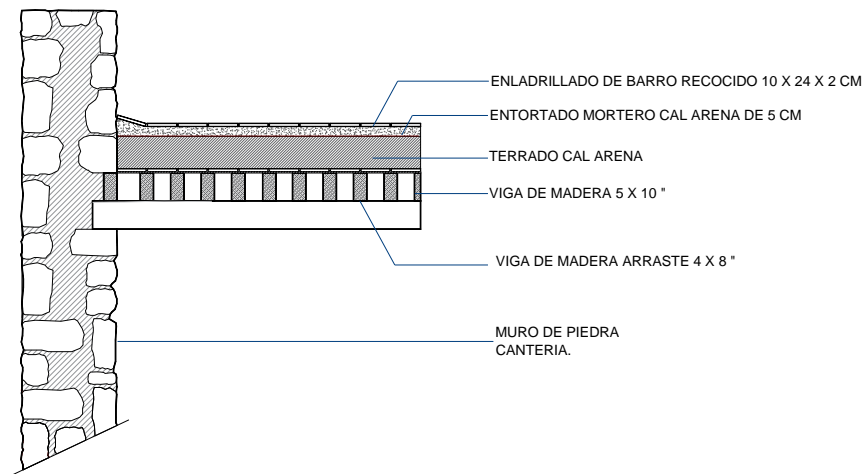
Detalle No. 2 vista del corte de la cubierta mostrando la viguería, el enladrillado y el terrado.
